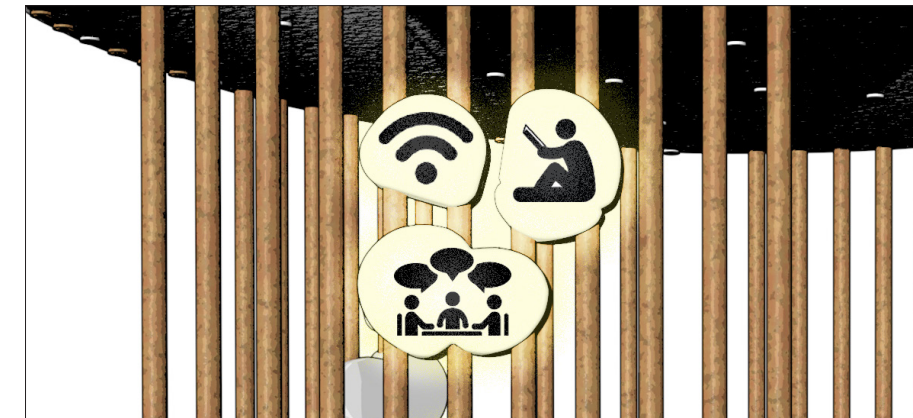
Vista de la señalética planteada, en este caso para la zona de mesas de trabajo y zona de descanso.
